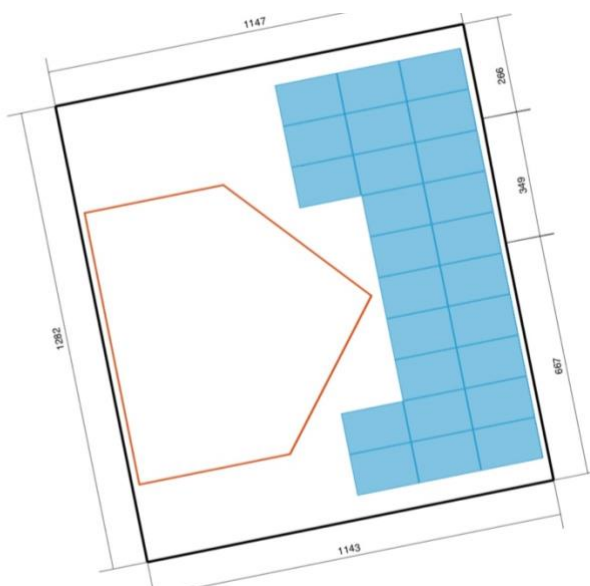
Lütschbachstrasse 3, Belegungsplan, Dachfläche 1:Westdach
